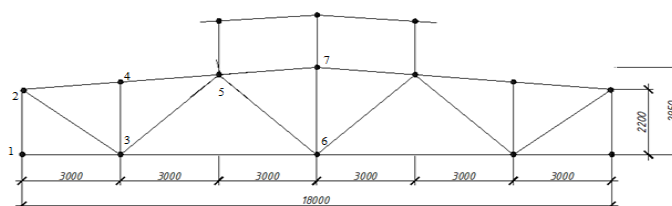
Расчетная схема стропильной фермы и варианты нагрузок
